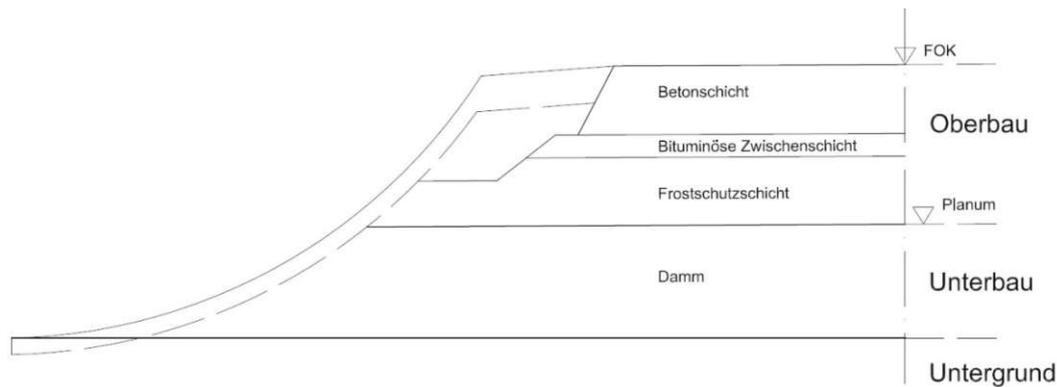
Schematischer Aufbau einer Betonstraße
